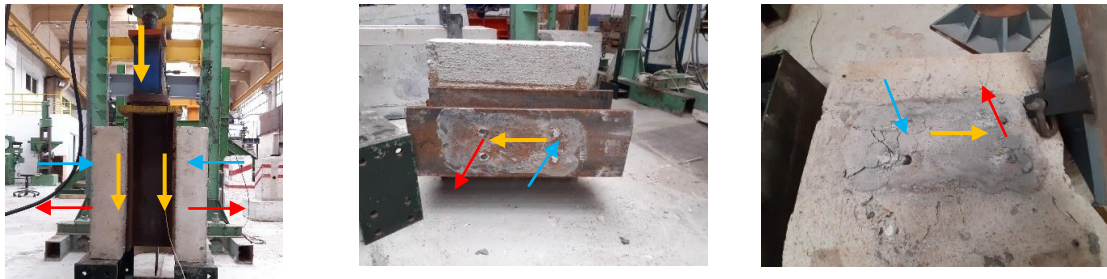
Vista general de la probeta (a), de la interfase metálica tras la rotura (b) y del hormigón y mortero (c). En color rojo se indican las tracciones y las compresiones en azul, fruto de la excentricidad del rasante.
